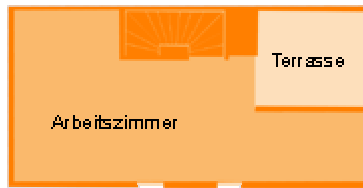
Grundriss 2. Obergeschoss
